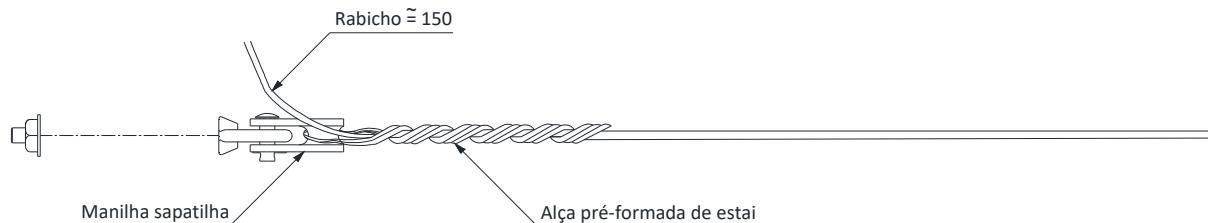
Amarrações e ligações – Ancoragem simples – Fim de linha – mensageiro
